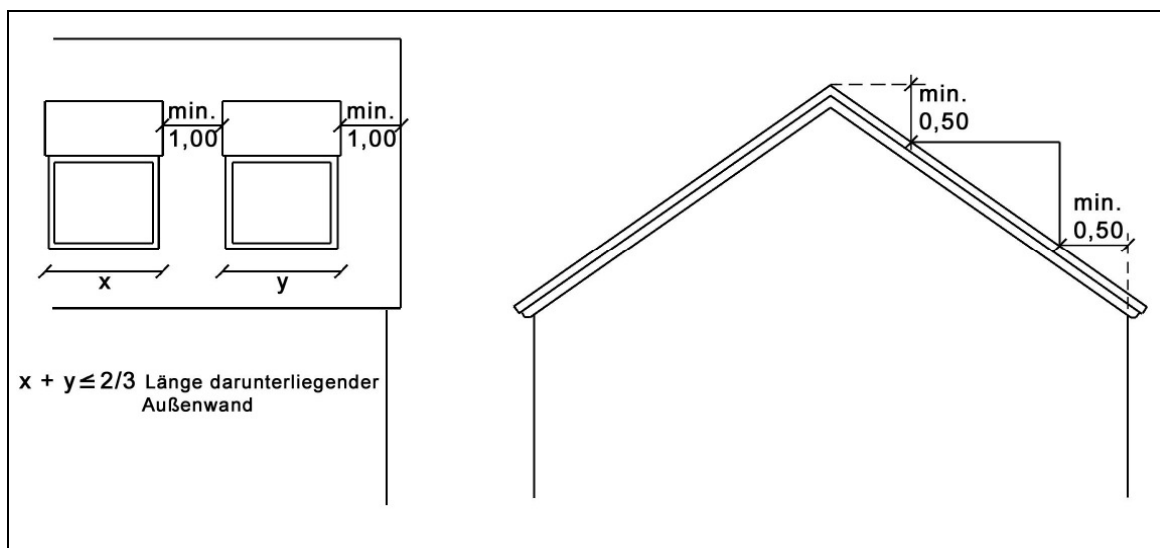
Skizze zu Dachaufbauten (ohne Maßstab)
